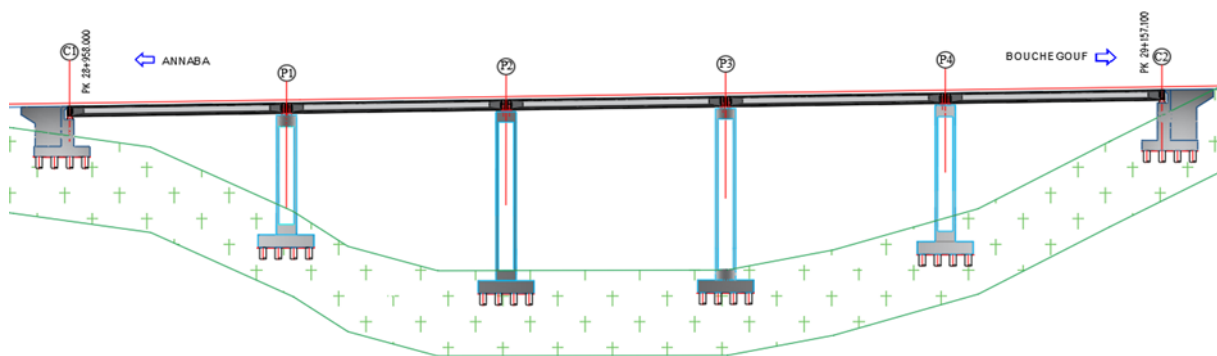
Schéma de la variante Pont à poutres préfabriquées précontraintes par post-tension
